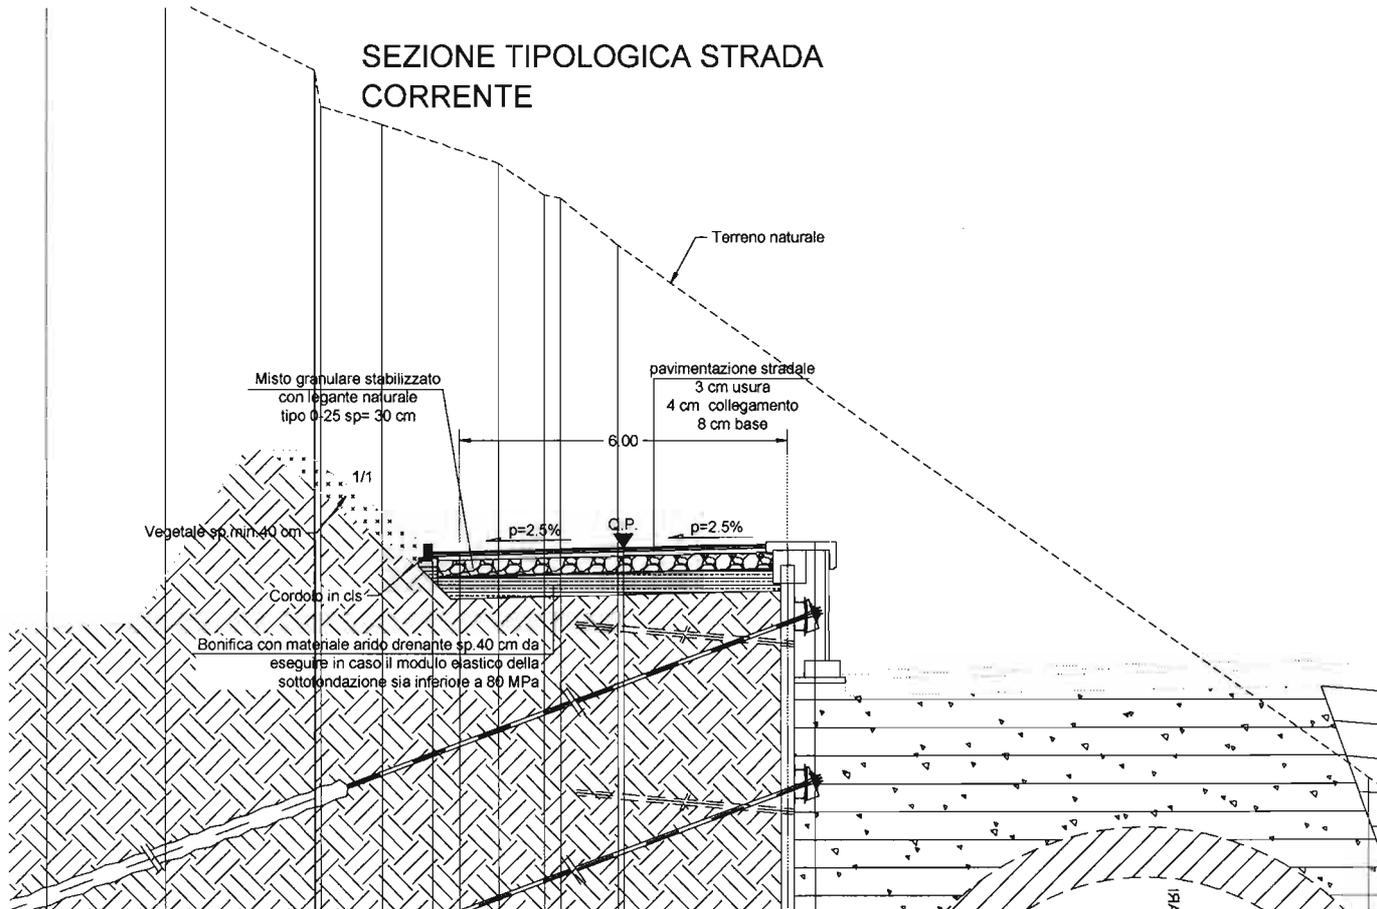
Sezione Tipo Strada Accesso Imbocco Gardena-Nord
